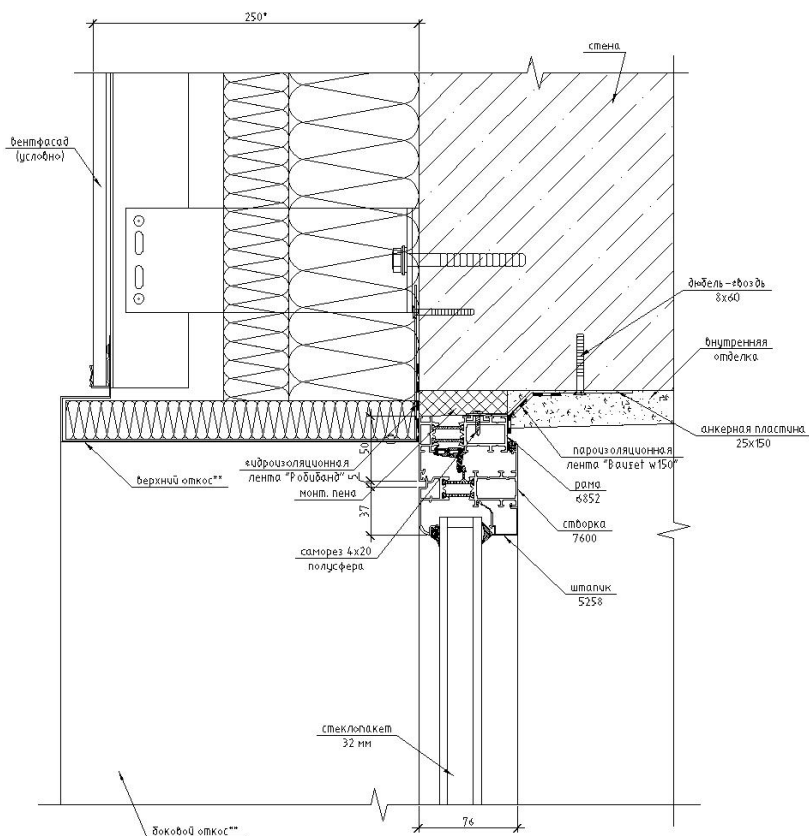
Верхний узел примыкания оконного блока к бетонной стене.
